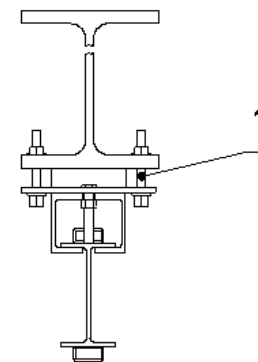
Крепление с помощью универсального кронштейна со сверлением отверстий в несущей конструкции
